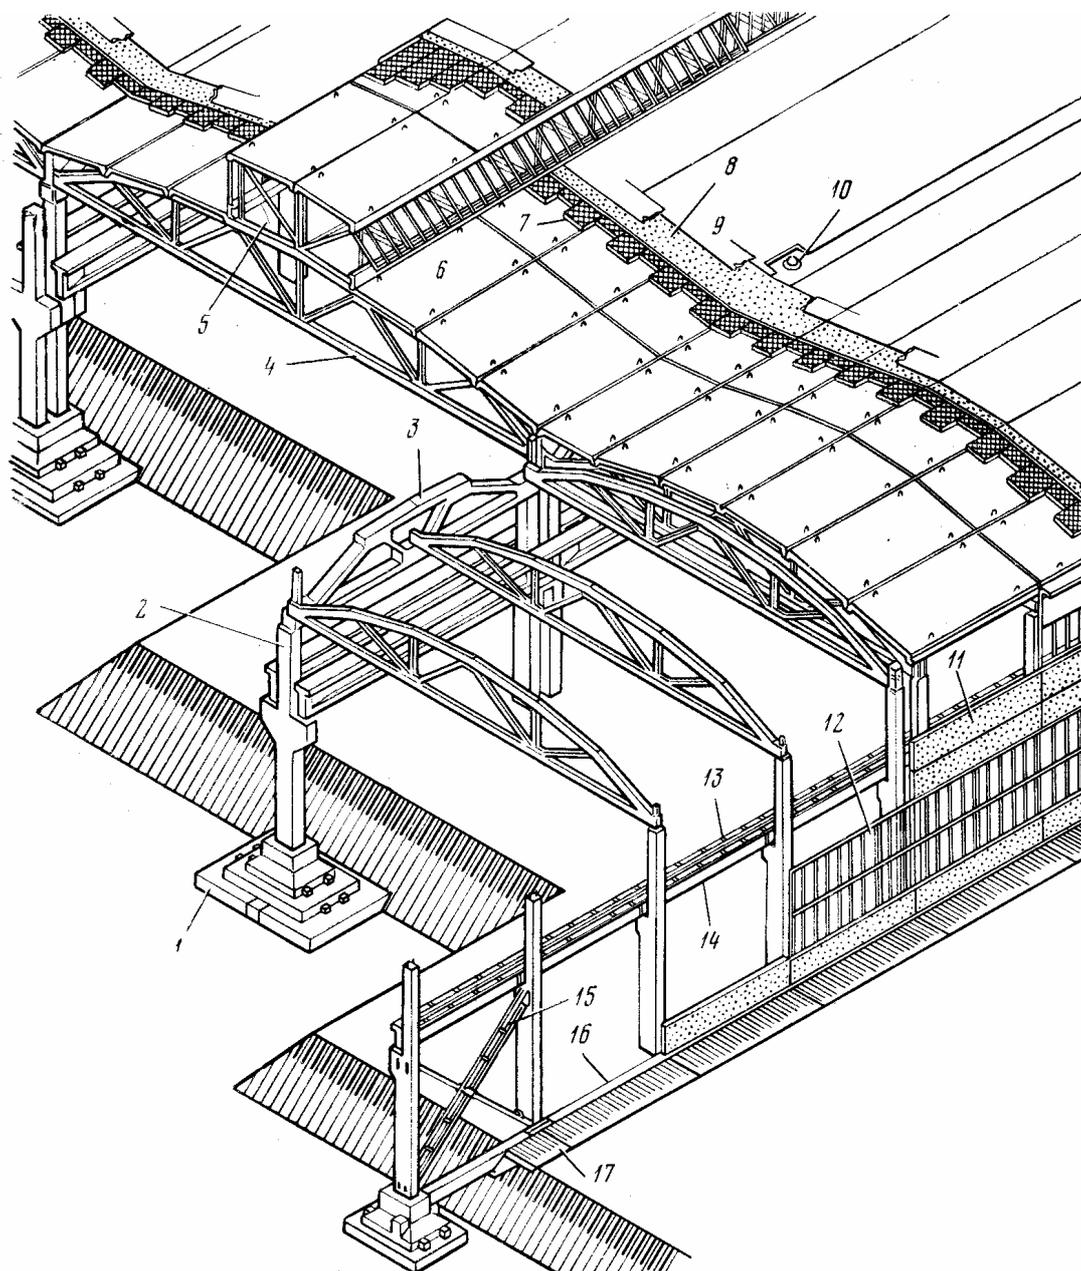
Схема промышленного здания каркасного типа: 1 – фундаментный башмак; 2 – колонна; 3 – подстропильная ферма; 4 – стропильная ферма; 5 – светоаэрационный фонарь; 6 – плита покрытия; 7 – утеплитель; 8 – выравнивающий слой; 9 – кровельный ковер; 10 – воронка внутреннего водостока; 11 – стенная панель; 12 – ленточное остекление; 13 – крановая рельса; 14 – подкрановая балка; 15 – связи; 16 – фундаментная балка; 17 – отмостка
